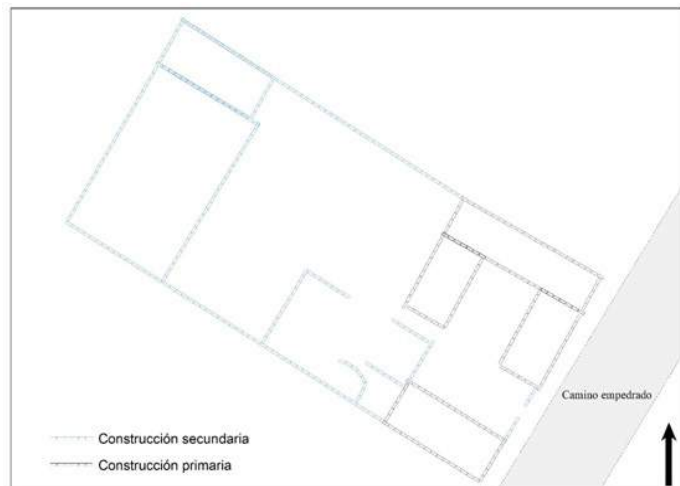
Plano simple de estructuras diferenciadas por técnica constructiva, las construcciones secundarias se encuentran rodeando y cerrando las construcciones primarias. Elaboración propia.
